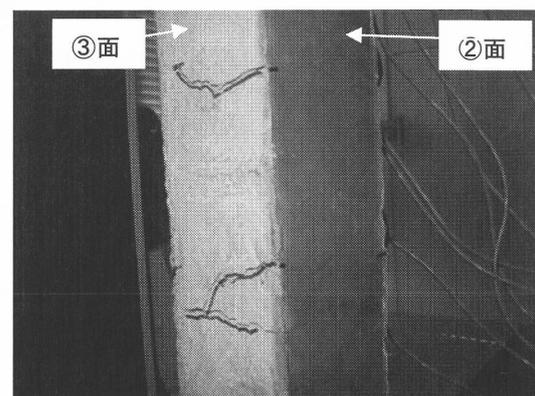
ひび割れ時の防水材の状況 (A体0.25mm時)
